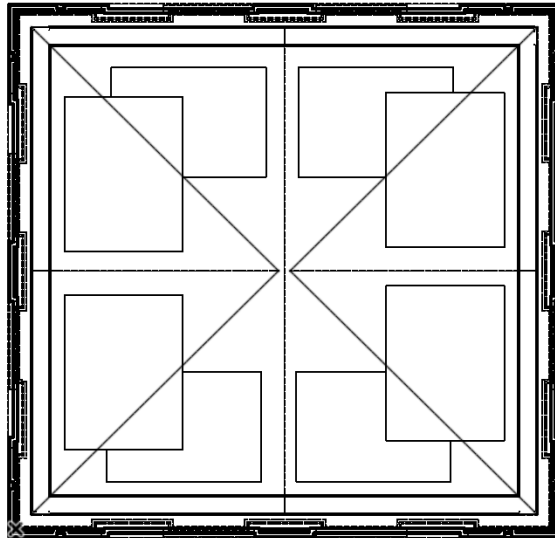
Zamosc_Grundriss_Dachaufsicht.png
